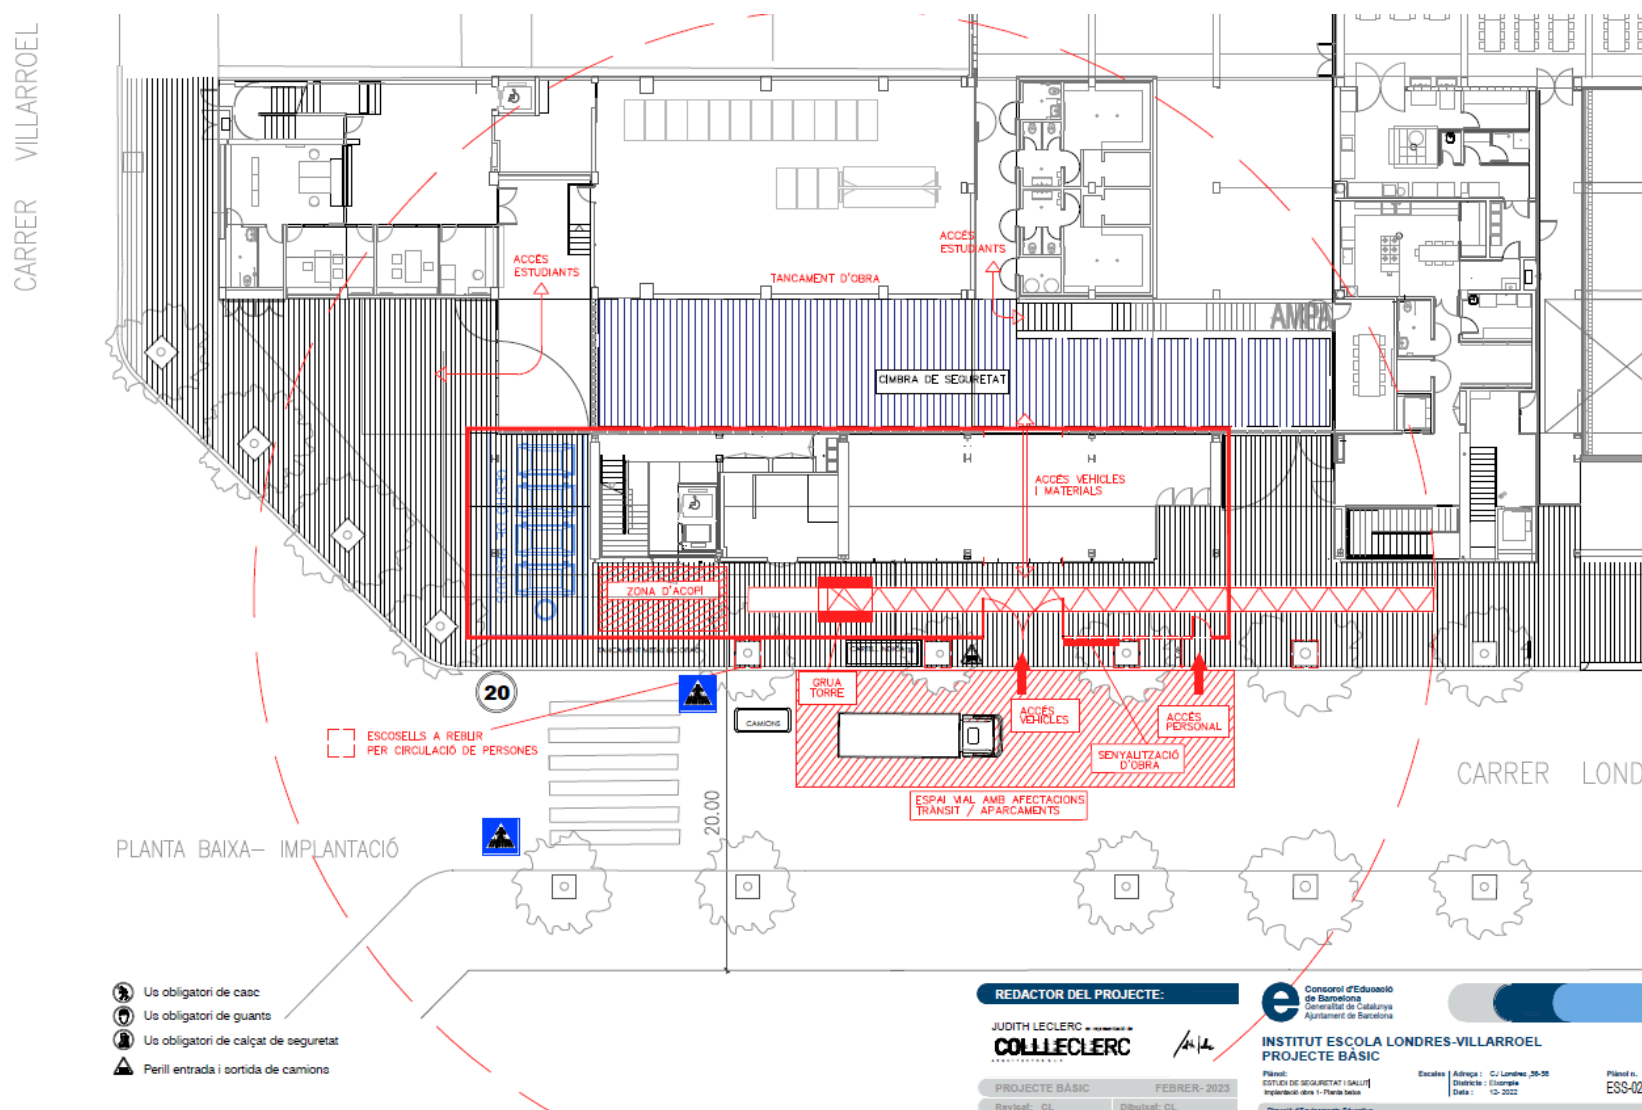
Organització de les obres. Planta baixa. Font: Projecte executiu
